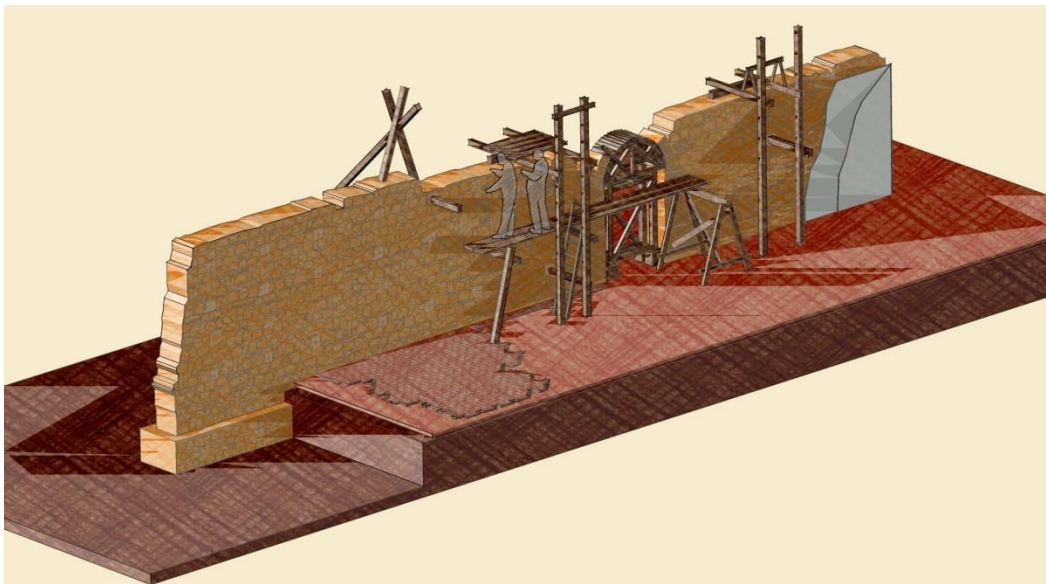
vista hipotética de una obra de mampostería en Panamá Viejo (Félix Durán - PPV).
